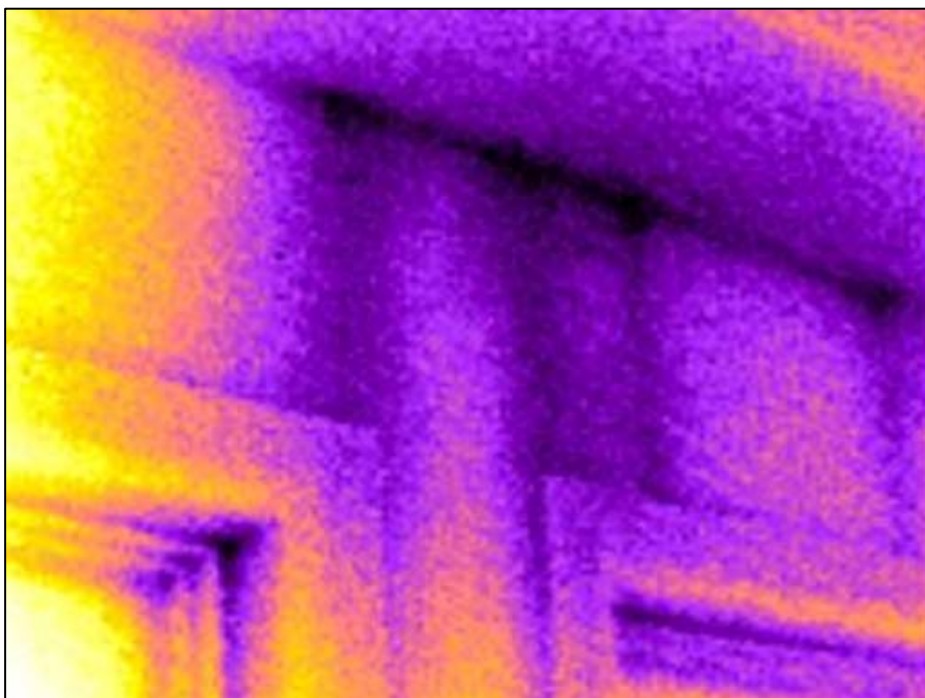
Patologias de infiltrações em trecho de laje de teto, viga e parede, com interpretação por meio de equipamento/dispositivo que utiliza a termografia por raios infravermelhos [7].
